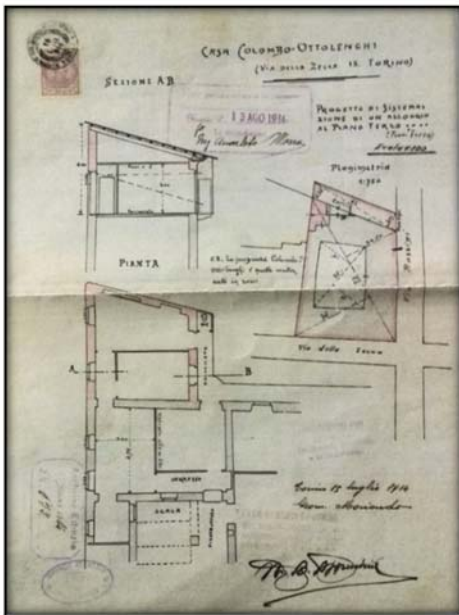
progetto di ristrutturazione appartamento Colombo – Ottolenghi, 1914
